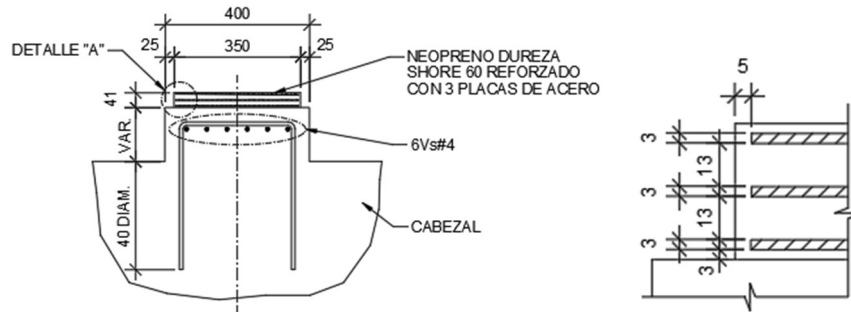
Apoyos móviles de neopreno para las vigas AASHTO IV
